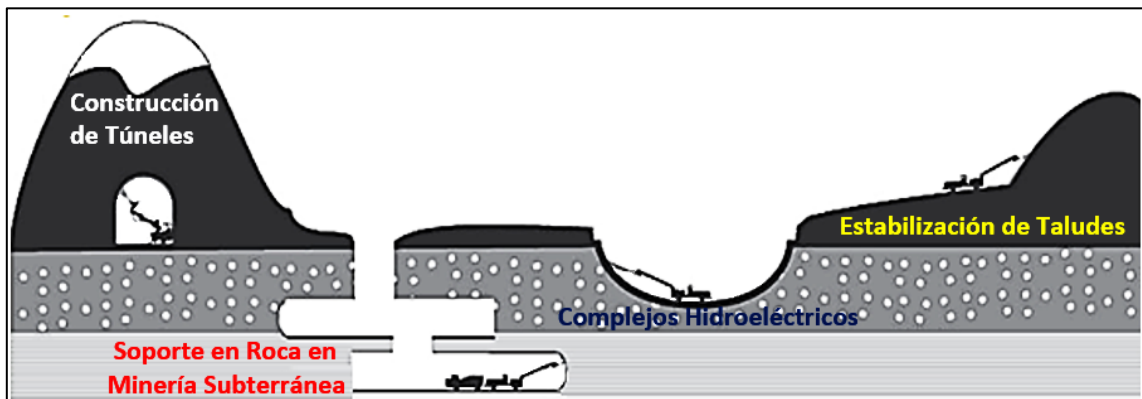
Aplicación del shotcrete vía húmeda
